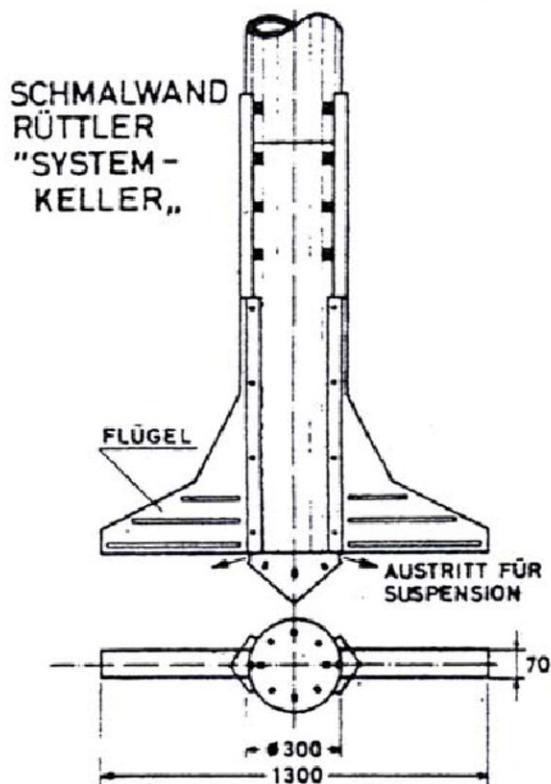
Tiefenrüttler mit angeschweissten Stahlelementen [4]
